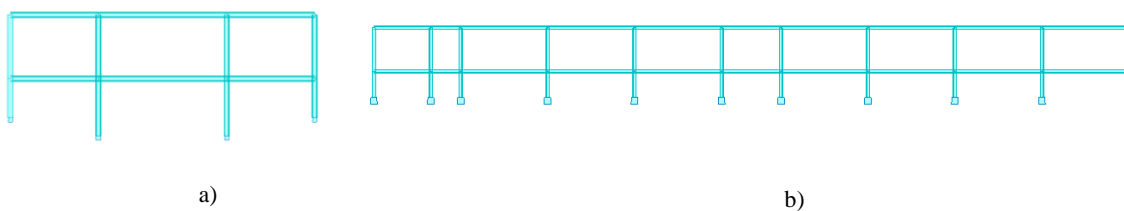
a) Pórtico da estrutura na direção xz; b) Pórtico da estrutura na direção yz.
